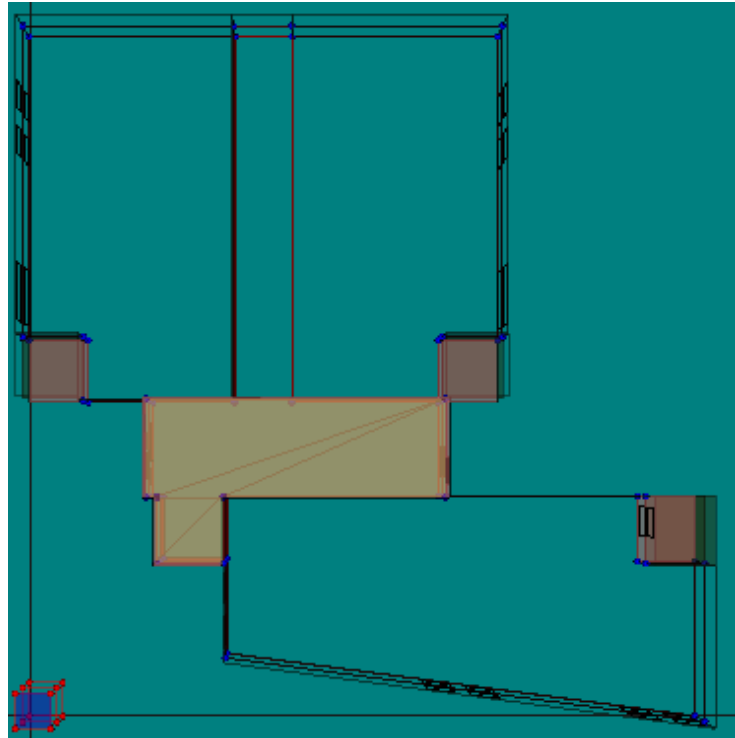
Vista planta de la planta cubierta. Fuente: Propia, HULC.
